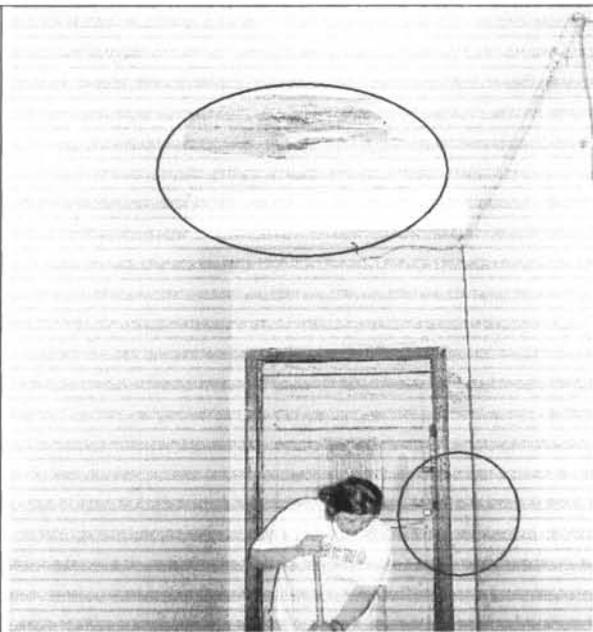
Deterioro interior de la edificación. Desprendimiento de acabados del entrepiso.
